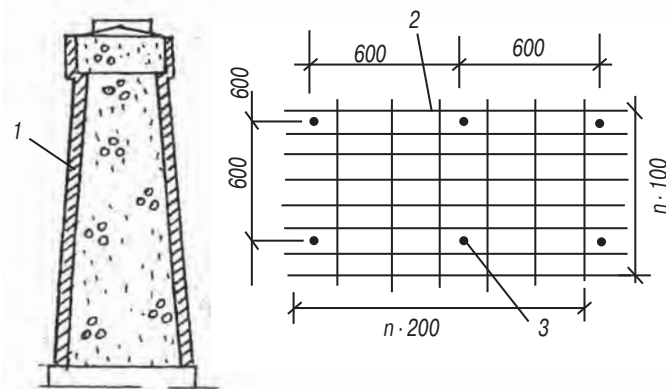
Железобетонная рубашка (оболочка) опоры: 1 – рубашка; 2 – арматурная сетка (диаметр арматуры 8–12 мм); 3 – анкер, заделываемый в скважину (диаметр стержней 16–20 мм)
